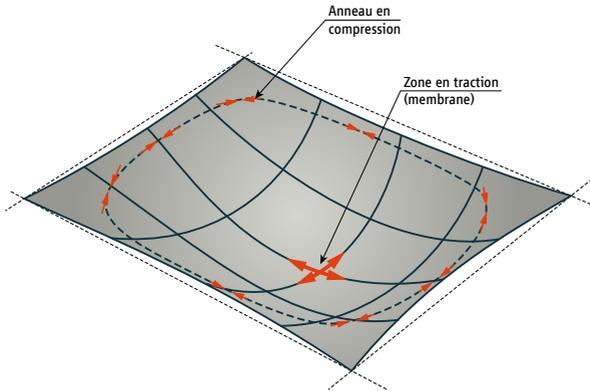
Comportement de membrane d'un plancher avec poutres mixtes en situation d'incendie
